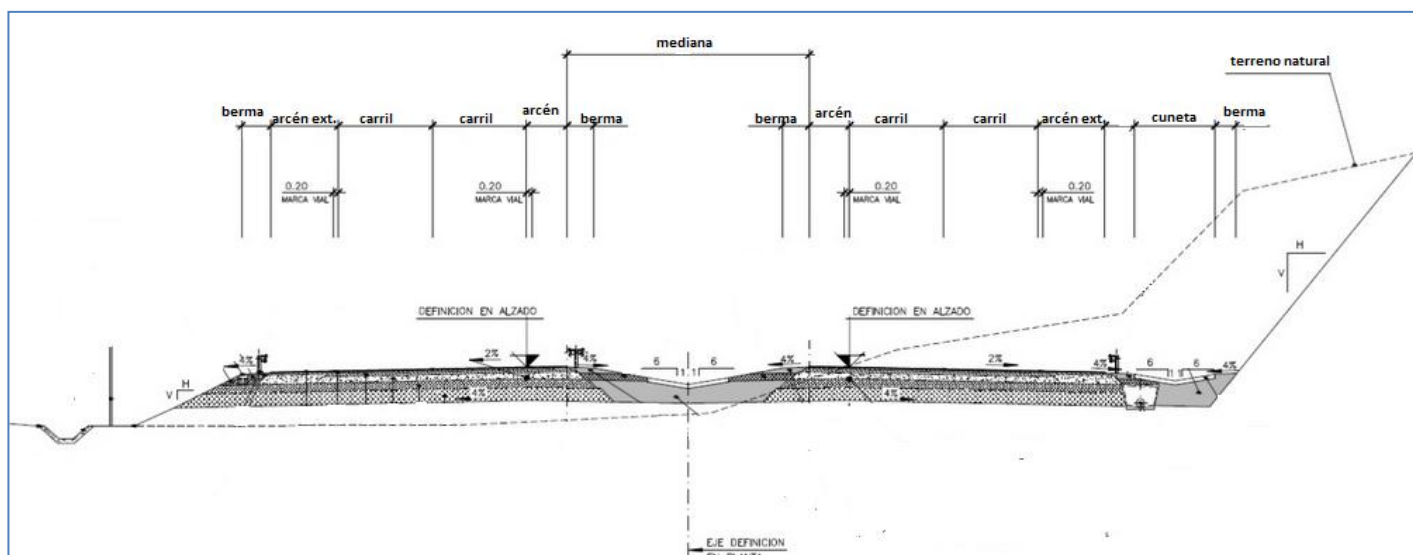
Sección tipo. Fuente: Instrucción de Trazado de Carreteras 3.1-IC.
